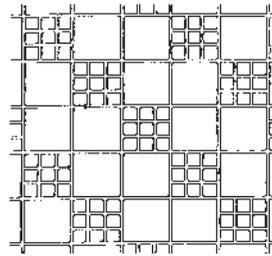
Formato cuadrado alternando con pavimento mosaico.
